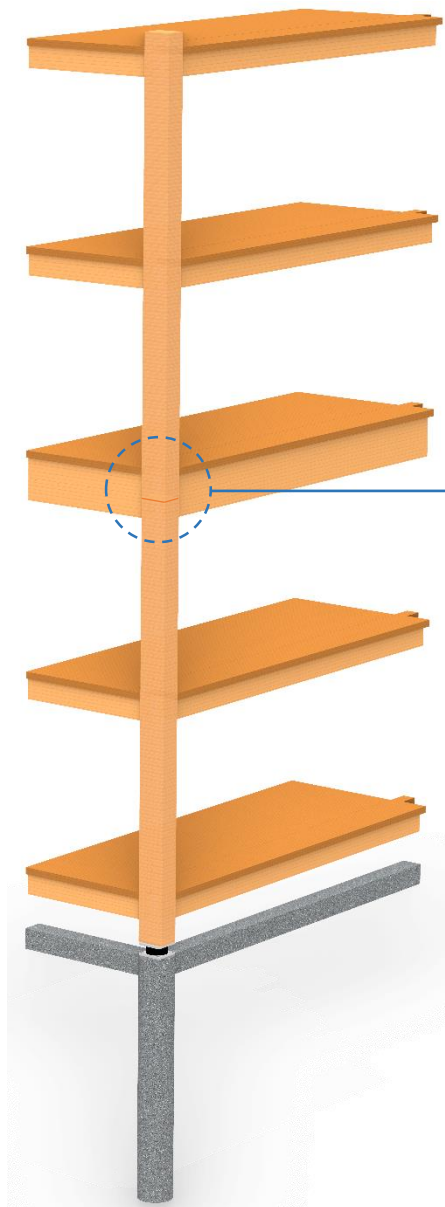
Sistema Estructural mixto doble modular con unión de plataforma. Elaboración Propia.
